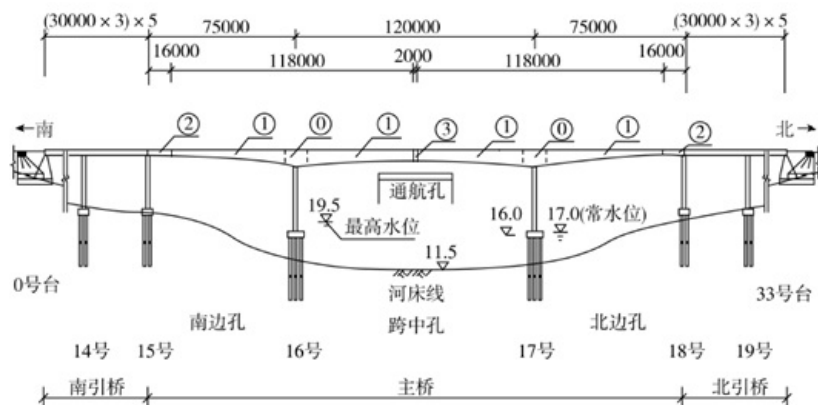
桥梁立面布置及主桥上部结构施工区段划分示意图(高程单位: m; 尺寸单位: mm)
